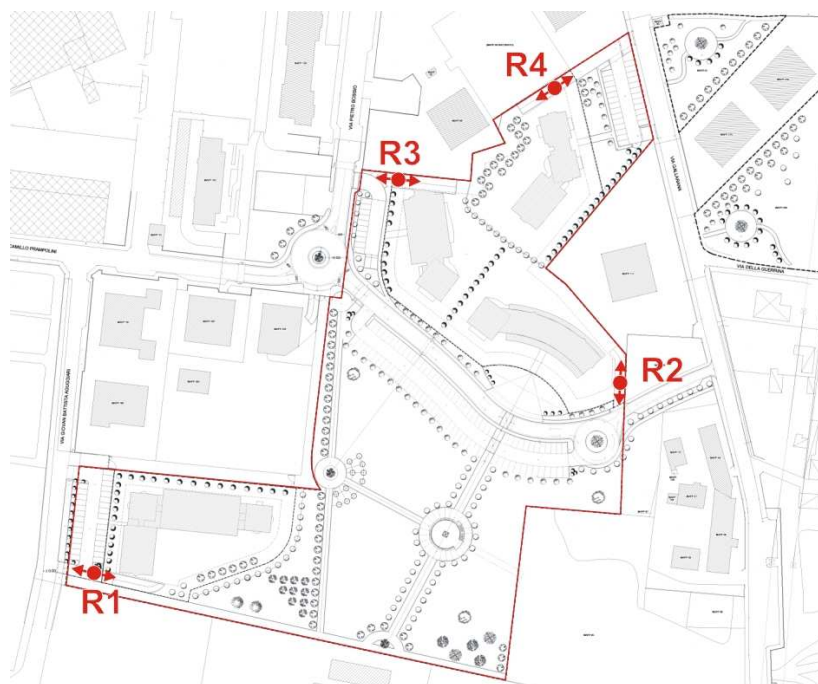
Planimetria di progetto - Rampe di accesso ai box
